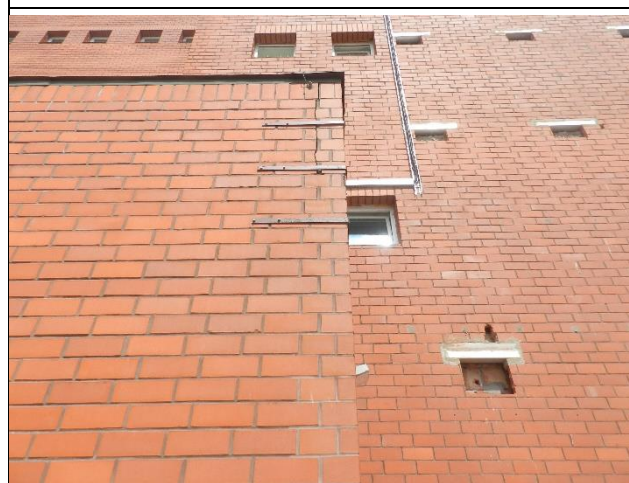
Uszkodzenie warstwy płytek elewacyjnych na betonowym wsporniku na elewacji zachodniej.
